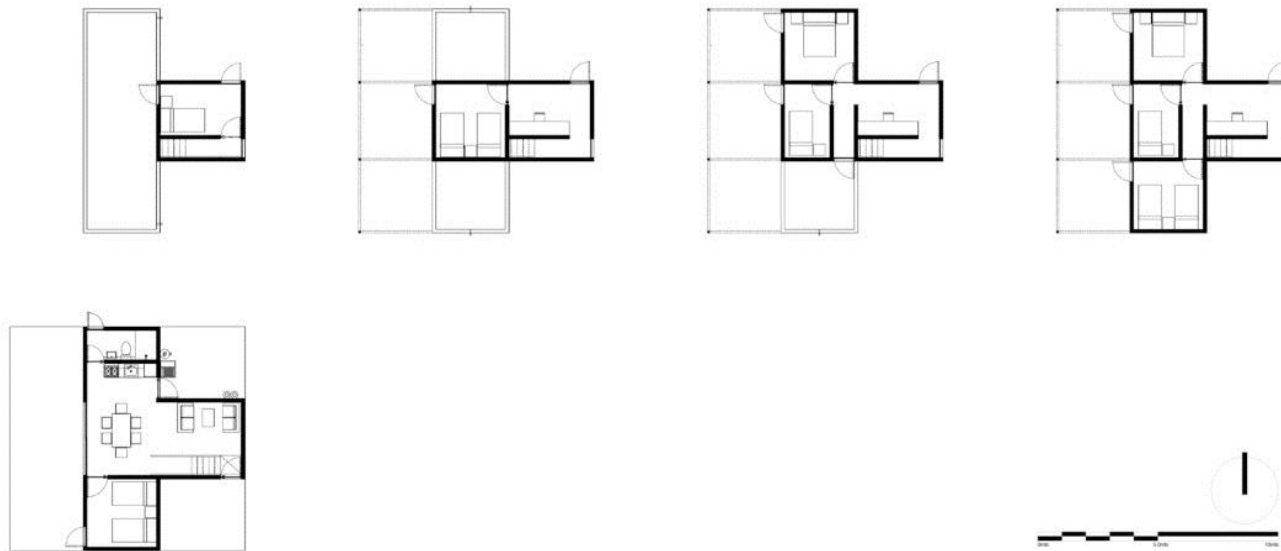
Prototipo Apan - Plantas (Planta baja en la esquina inferior izq. En la fila superior, la planta alta en sus diferentes fases)
